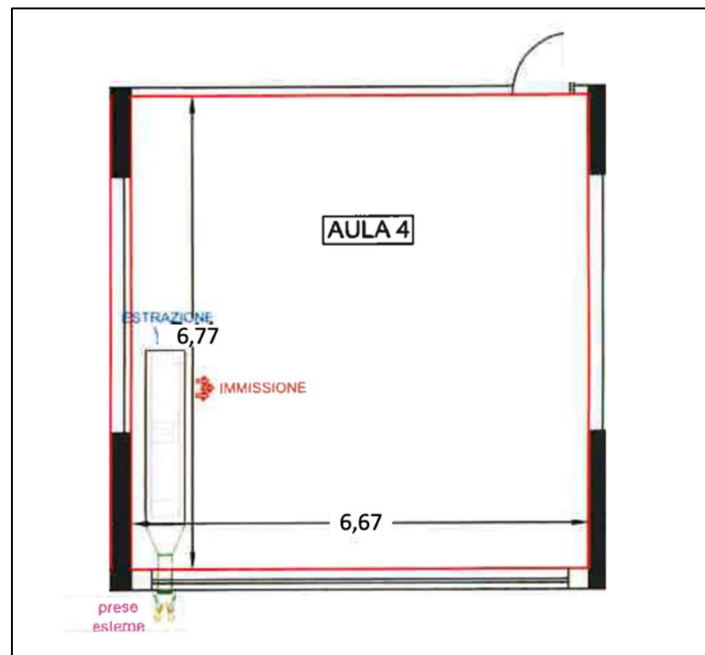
Planimetria dell'aula 3°B oggetto di misurazioni
